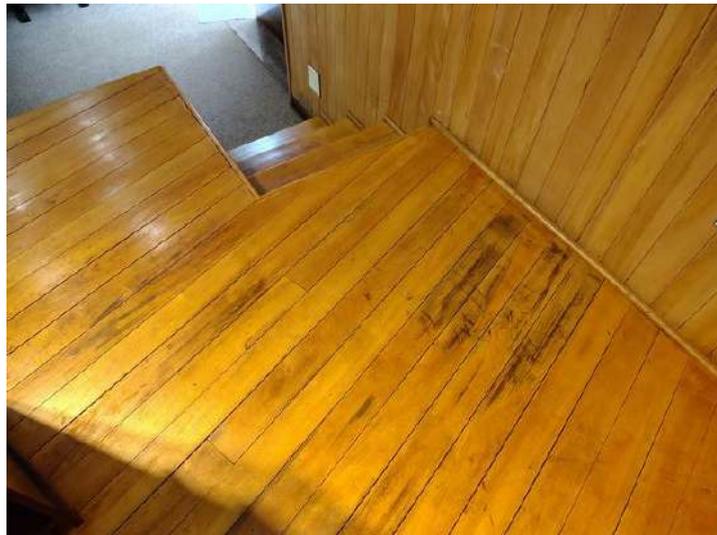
Auditório – Tablado com madeiras desgastadas
